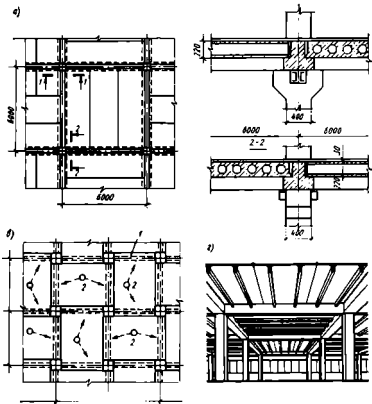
Перекрестная укладка настилов в перекрытии:
